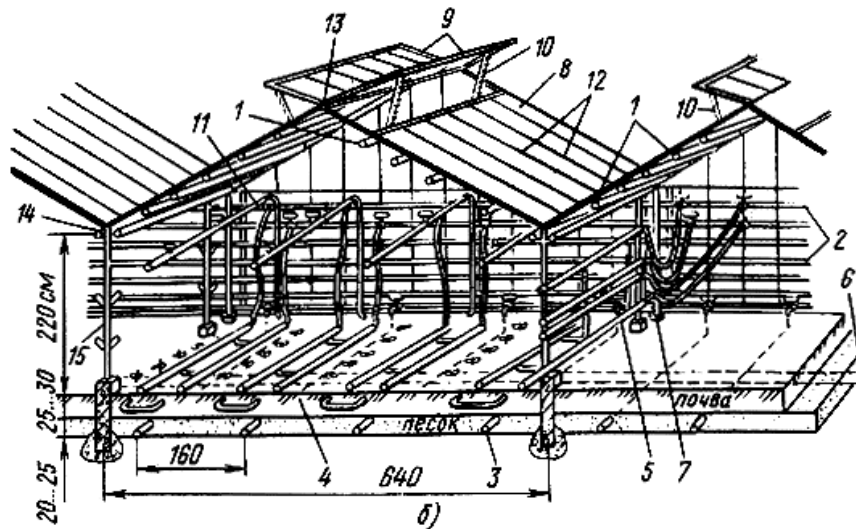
б. Основні будівельні елементи блокових теплиць: 1 – шатровий обігрів; 2 – боковий обігрів; 3 – підґрунтовий обігрів; 4 – надґрунтовий обігрів; 5 – труби надґрунтового обігріву; 6 – ґрунтовий дренаж; 7 – водостік; 8 – покрівля; 9 – кватирки; 10 – рейка; 11 – зрошувач; 12 – шпроси; 13 – коньковий гребінь; 14 – водостічний жолоб; 15 – стояк
